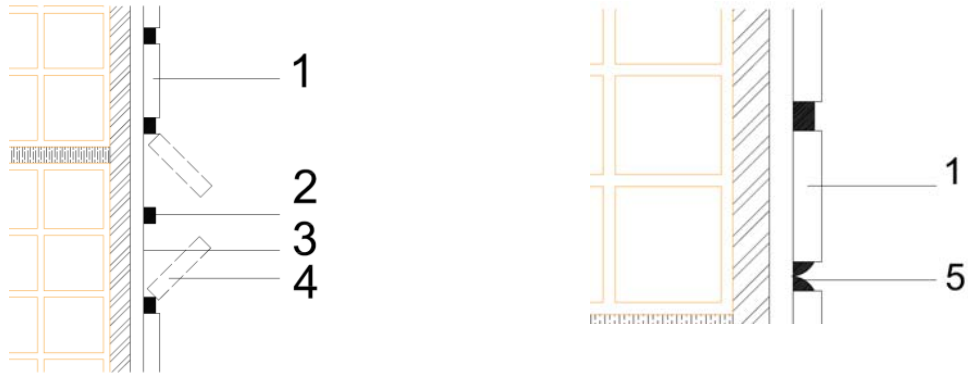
Destacamento do Cerâmico Colado. Figura 15 - Fissuração das Juntas do Cerâmico.
